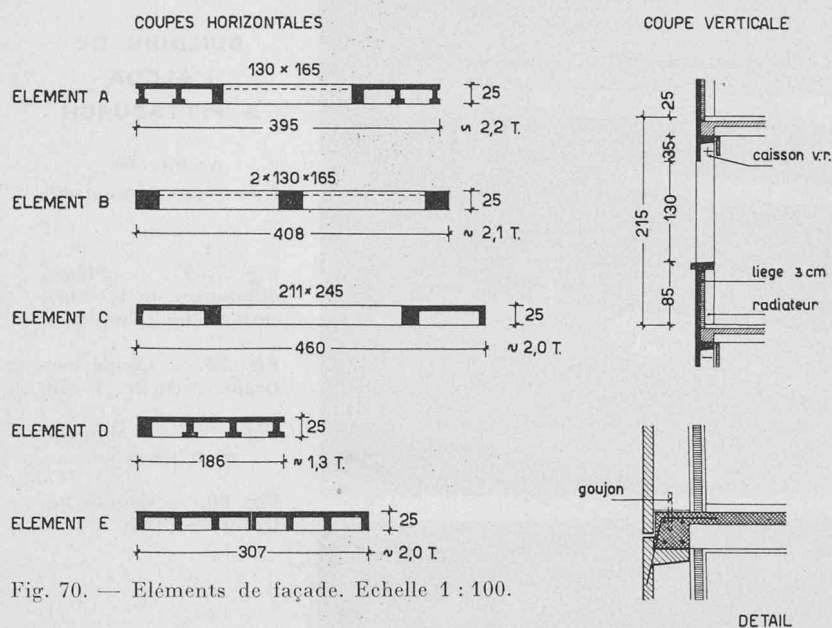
Eléments de façade. Echelle 1 : 100.
